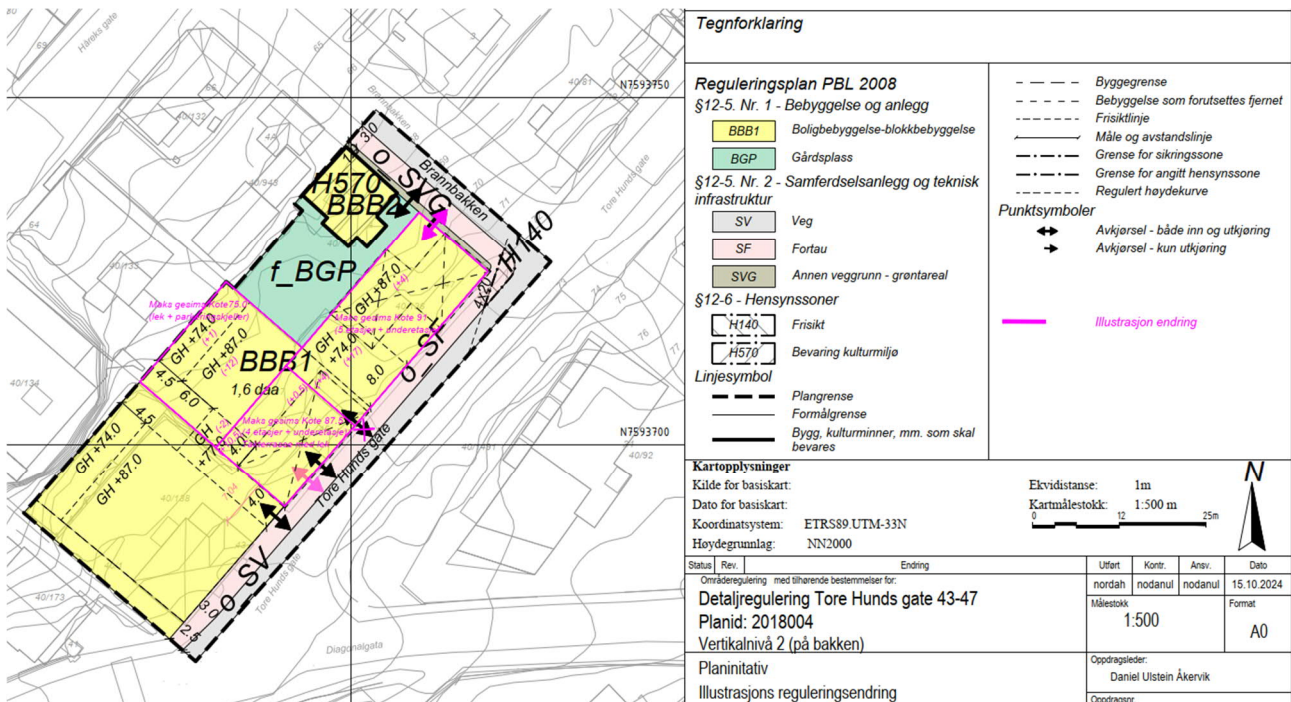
Illustrasjon av bygningsvolum i gjeldende plan. Kilde: Boarch
